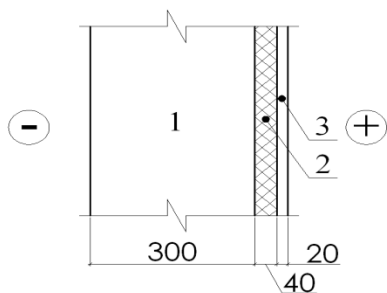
Конструктивная схема наружной стены для производственного здания с утеплителем толщиной 40 мм
